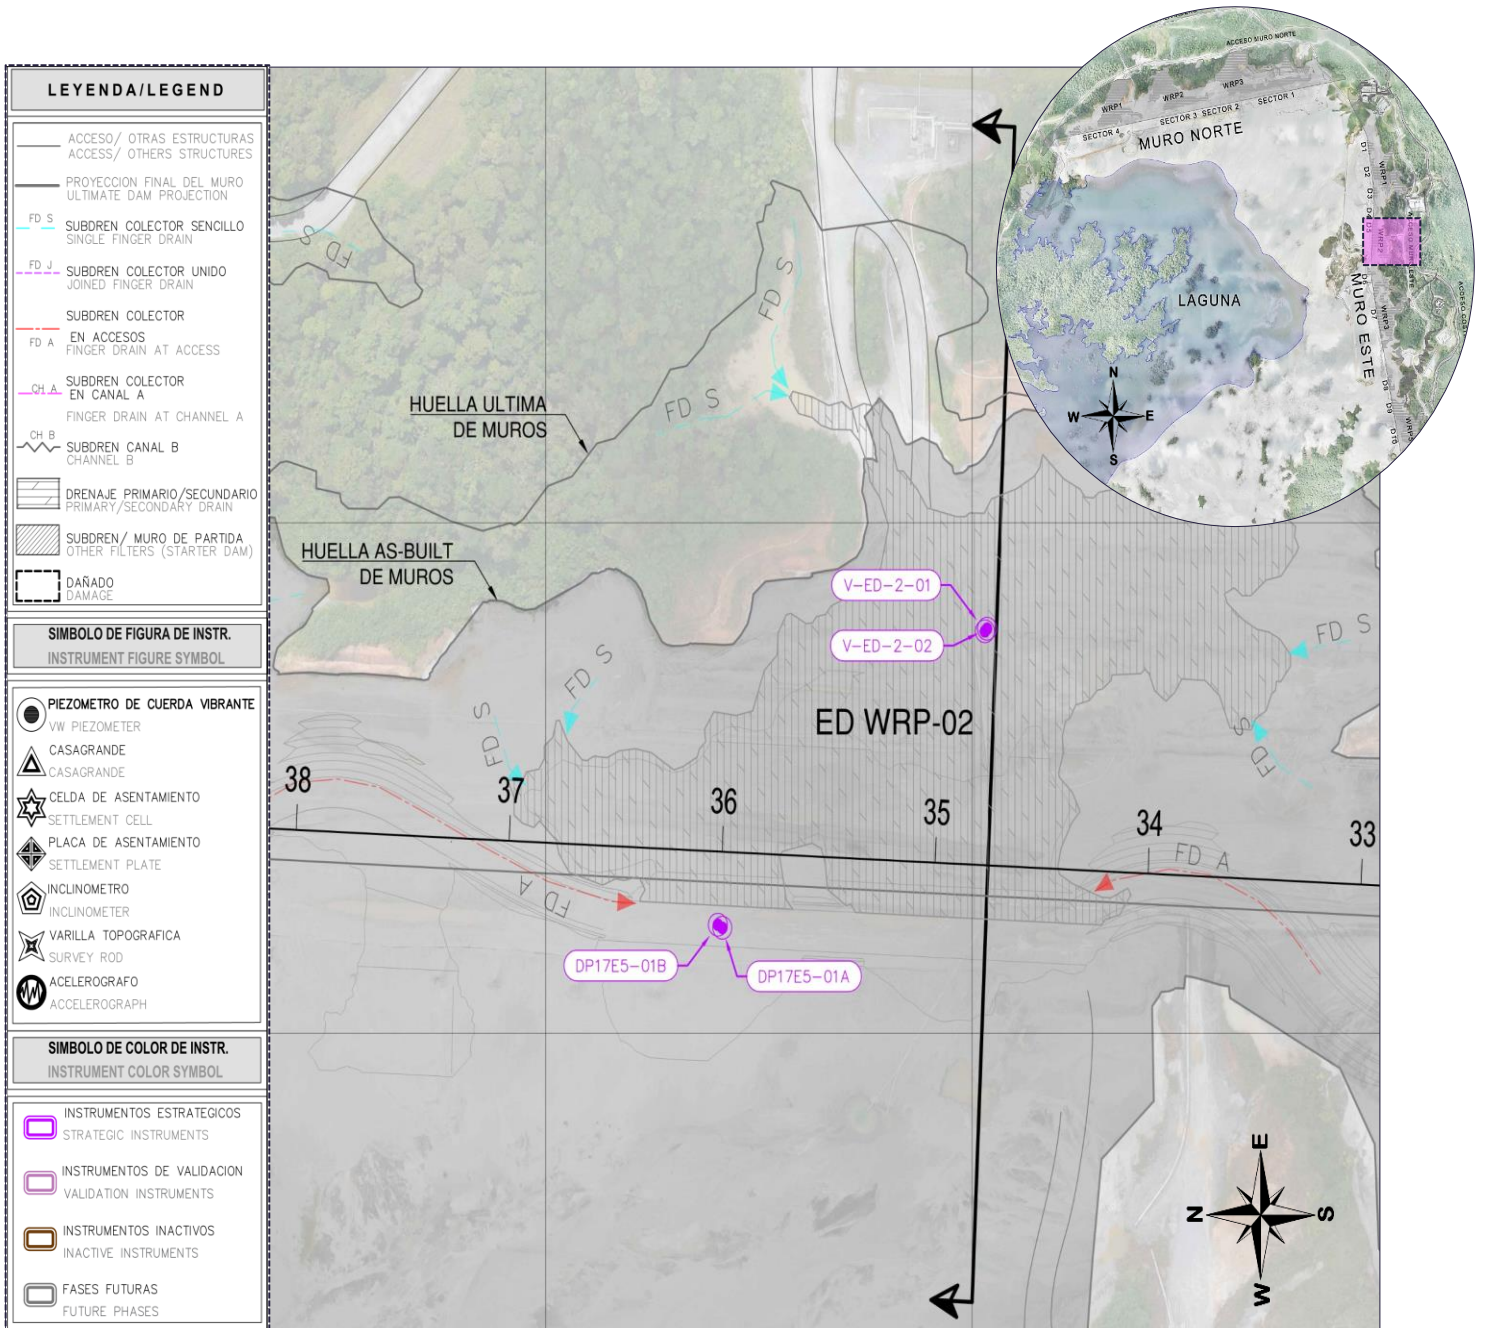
Vista de Planta en el Muro Este WRP2 con Piezómetros
